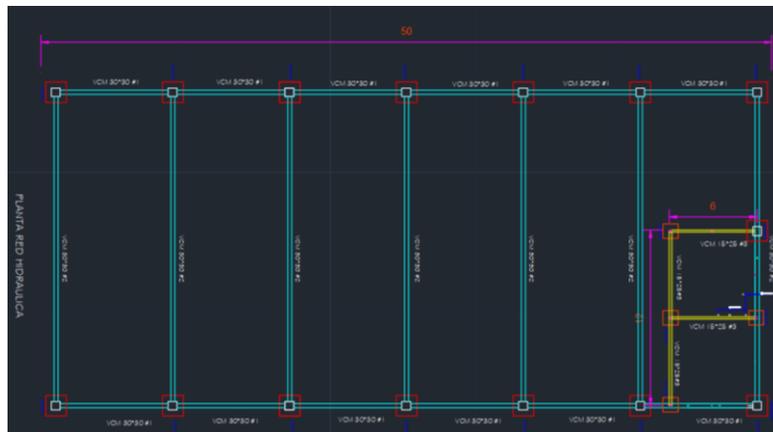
Planta Red Hidráulica Fuente: Elaboración propia
